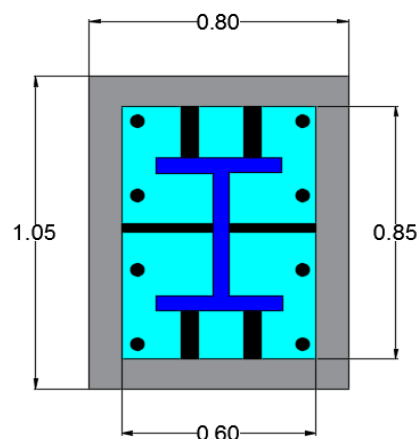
17. Detalle placa base y pernos de anclaje
